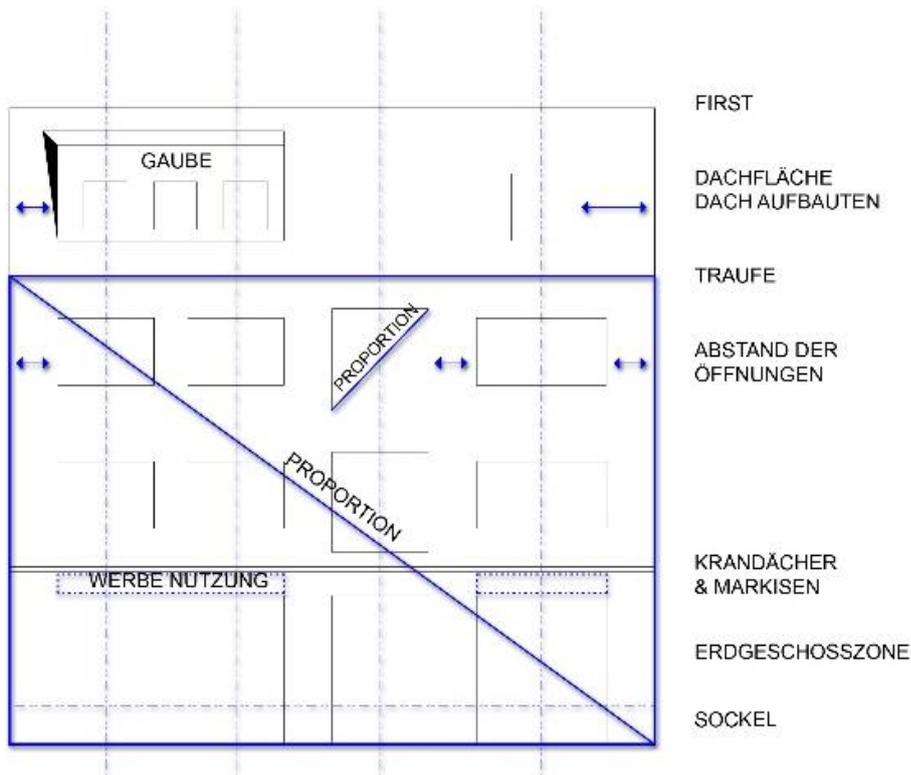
Schema zum Gebäudeaufbau sowie den Themen zur Gestaltung
